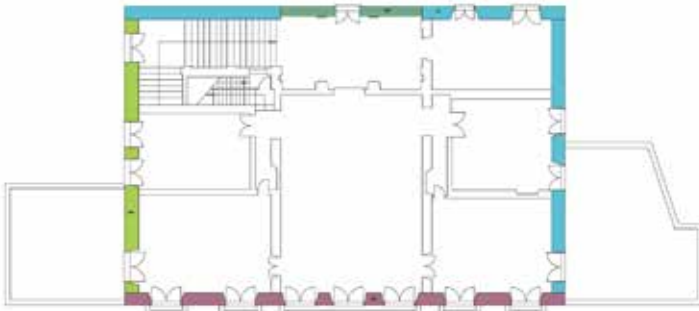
Individuazione dei diversi tipi di muratura dell'involucro opaco al Piano Secondo.
